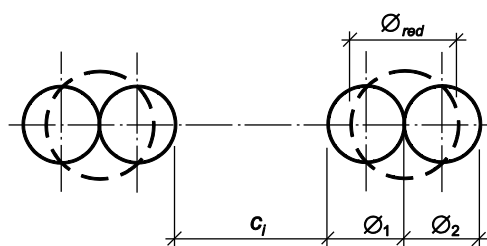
Расстояние между стержнями арматуры при ее установке в стесненных условиях
